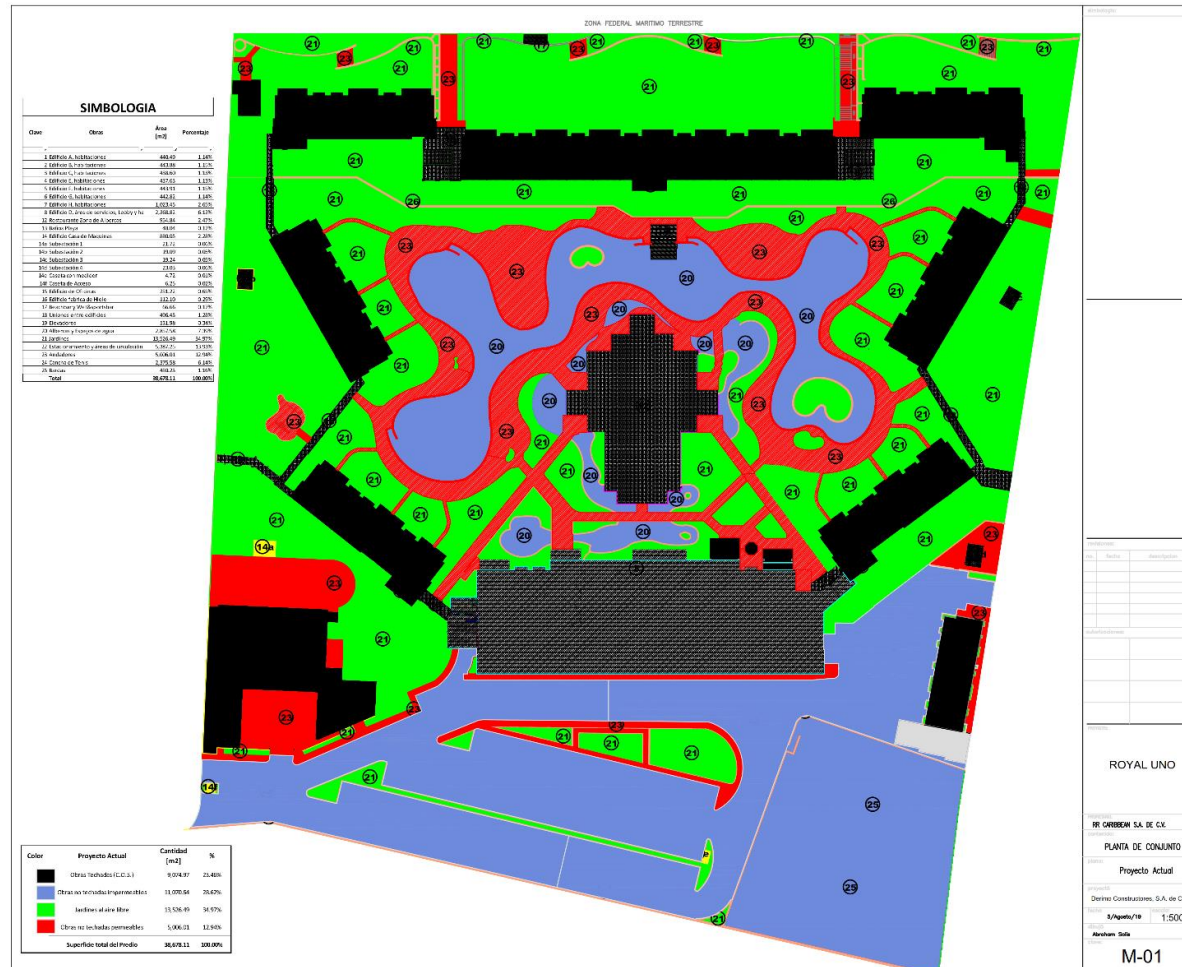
Se muestra el plano de conjunto de Proyecto actual (Anexo C-1). En el Anexo C-2 se presentan los planos por nivel que conforman actualmente el Proyecto.
